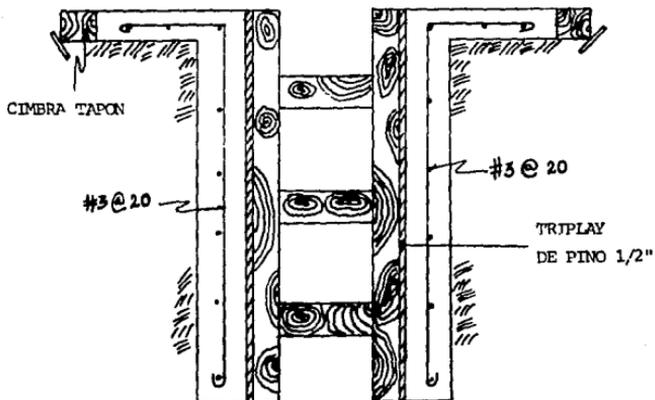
BROCAL CIMBRA Y ARMADO.
